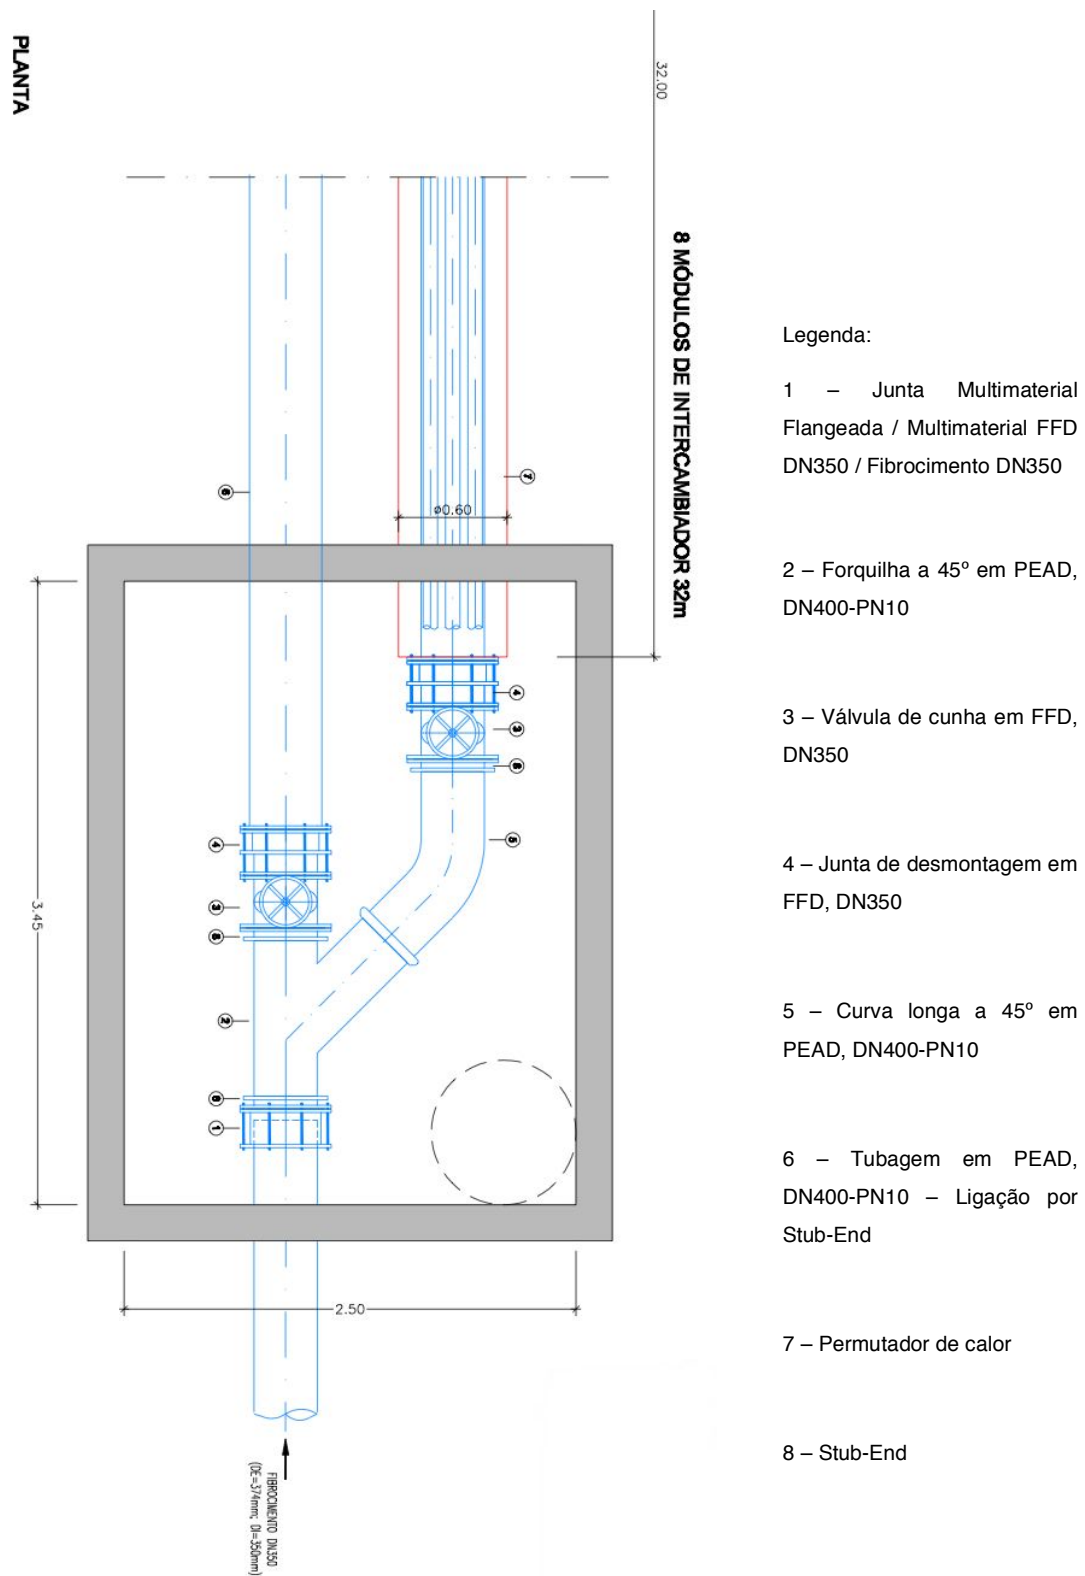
Planta esquemática de pormenor do coletor térmico.
